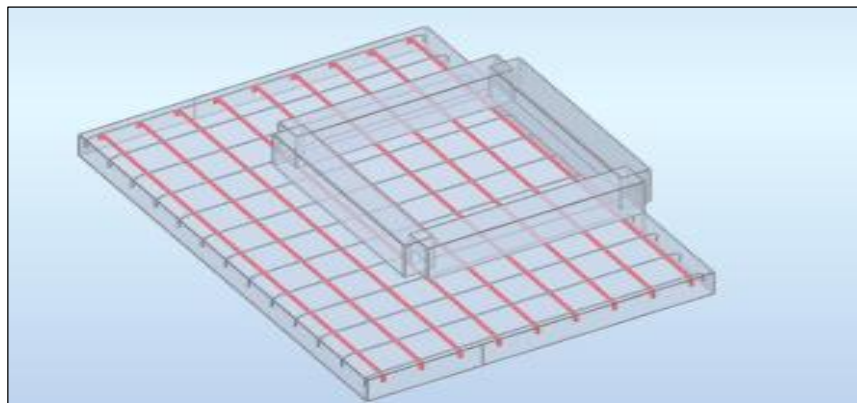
Dimensionamiento preliminar de la losa de cimentación ascensor
